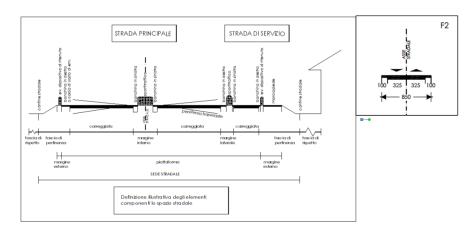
DEFINIZIONE ILLUSTRATIVA DEGLI ELEMENTI COMPONENTI LO SPAZIO STRADALE
